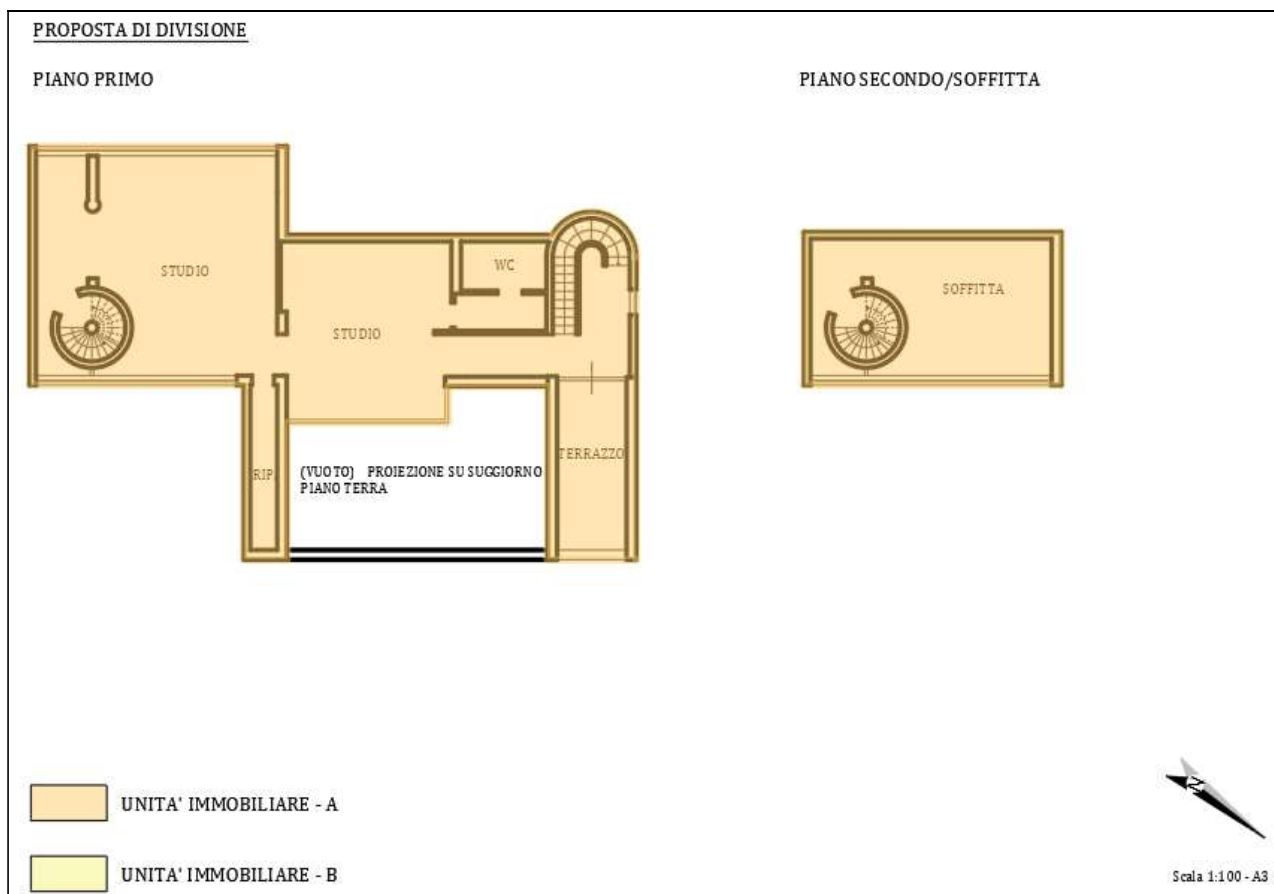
Planimetria dell'immobile PROPOSTA DI DIVISIONE – Piano primo e piano secondo/soffitta
